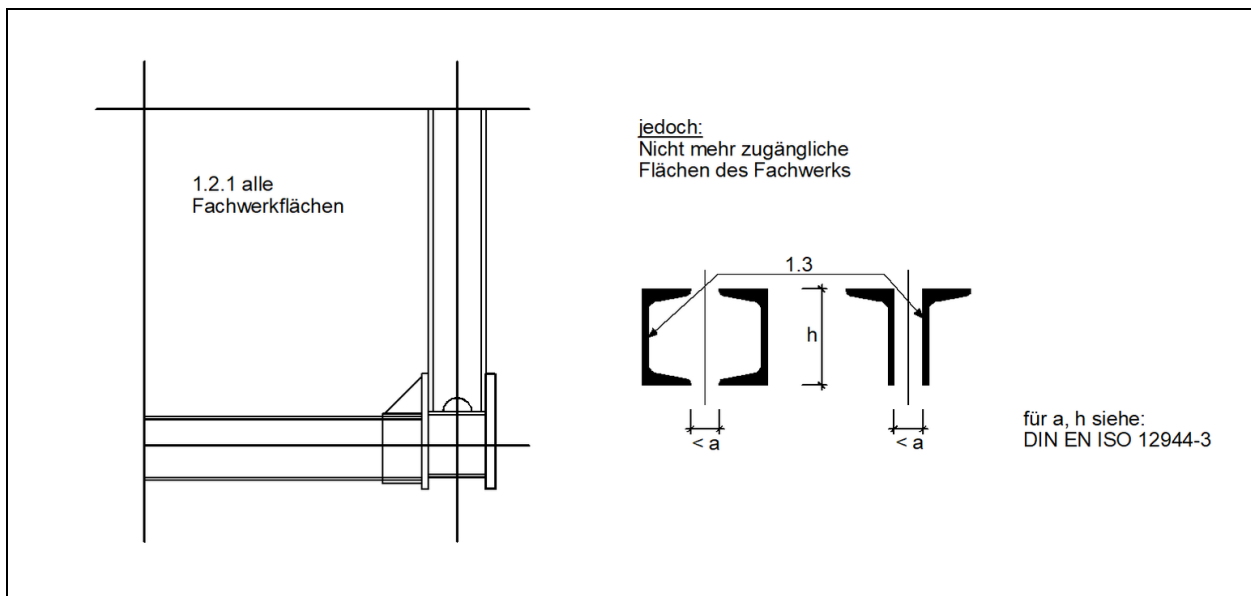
Teilquerschnitt einer Fachwerkkonstruktion
